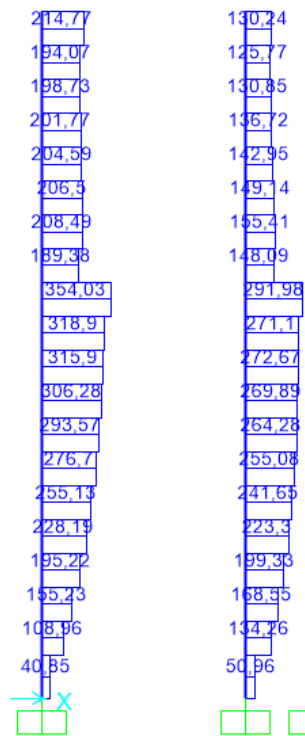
Esfuerzos cortantes en columnas, pórtico C
